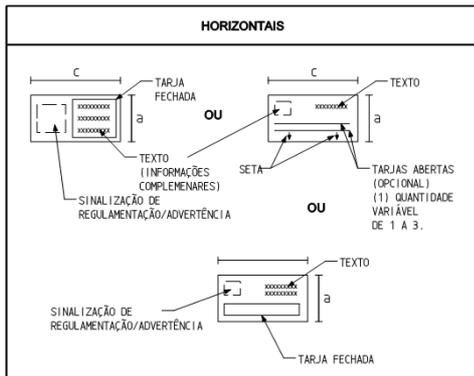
Tipos esquemáticos de placas especiais do tipo horizontal (construção de células / cadastro).
